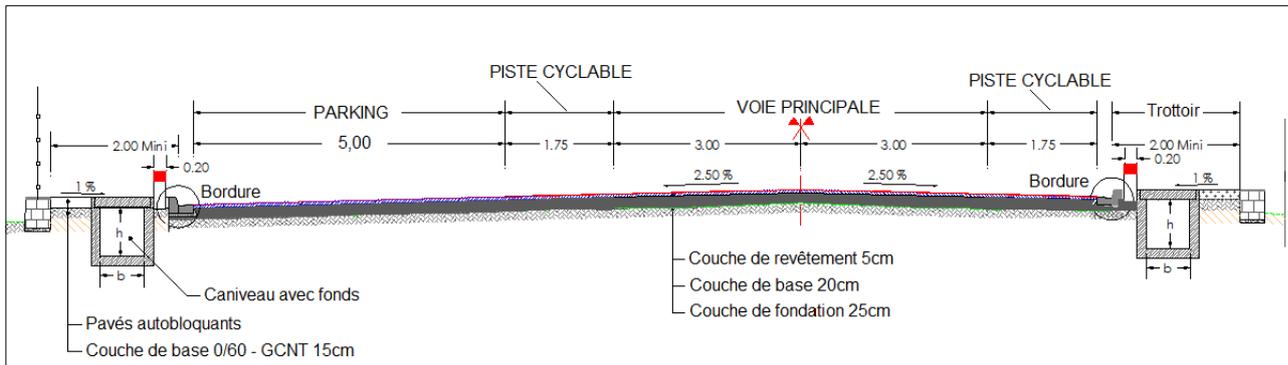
CHAUSSEE AVEC 2 PISTES CYCLABLES ET 1 UNE VOIE DE PARKING
